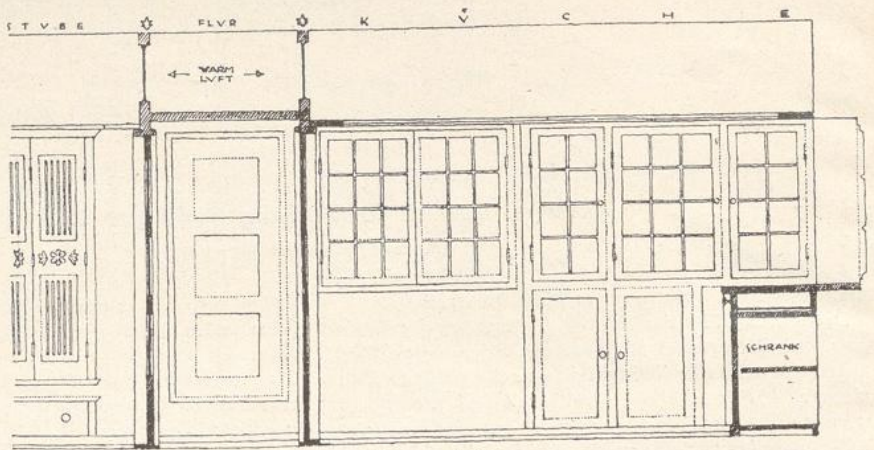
Grundriß der eingebauten Erdgeschosswohnung. (1:50)
